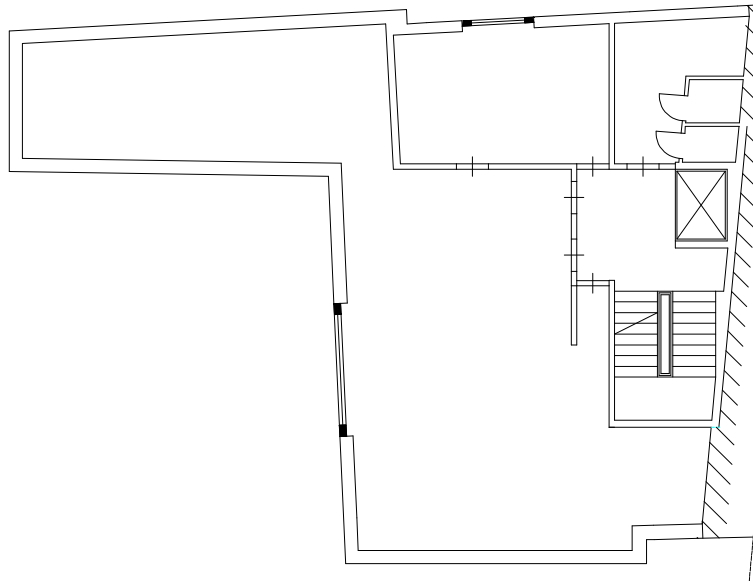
Planimetria del piano sottotetto del nuovo municipio
